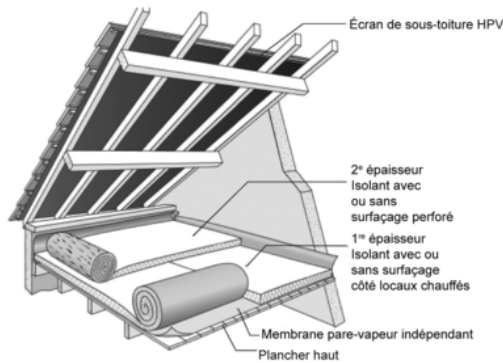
Isolation sur deux couches croisées en combles sur plancher bois
